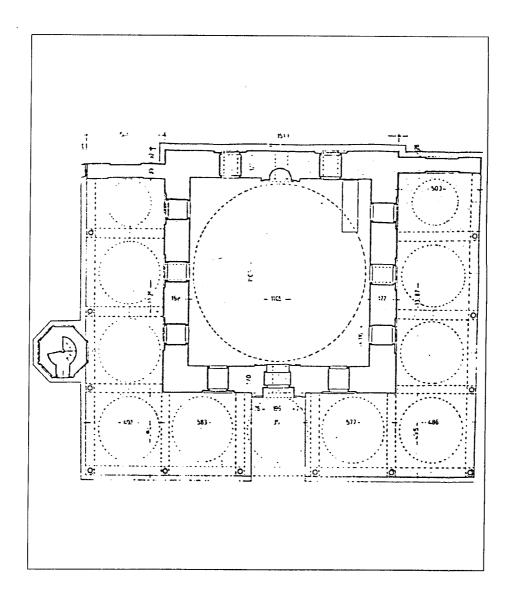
مكرر) مسقط أفقي لمسجد بايزيد يلدريم أو مسجد خداوند كار في أدرنة (عن : كوران) .
